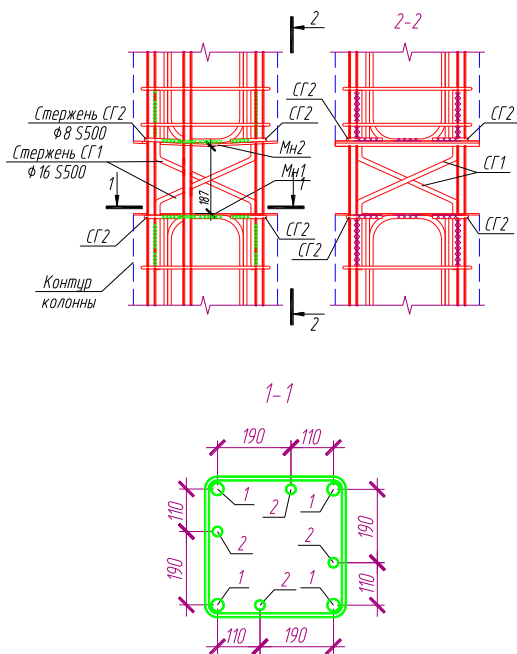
Армирование колонны в уровне монолитного диска перекрытия
